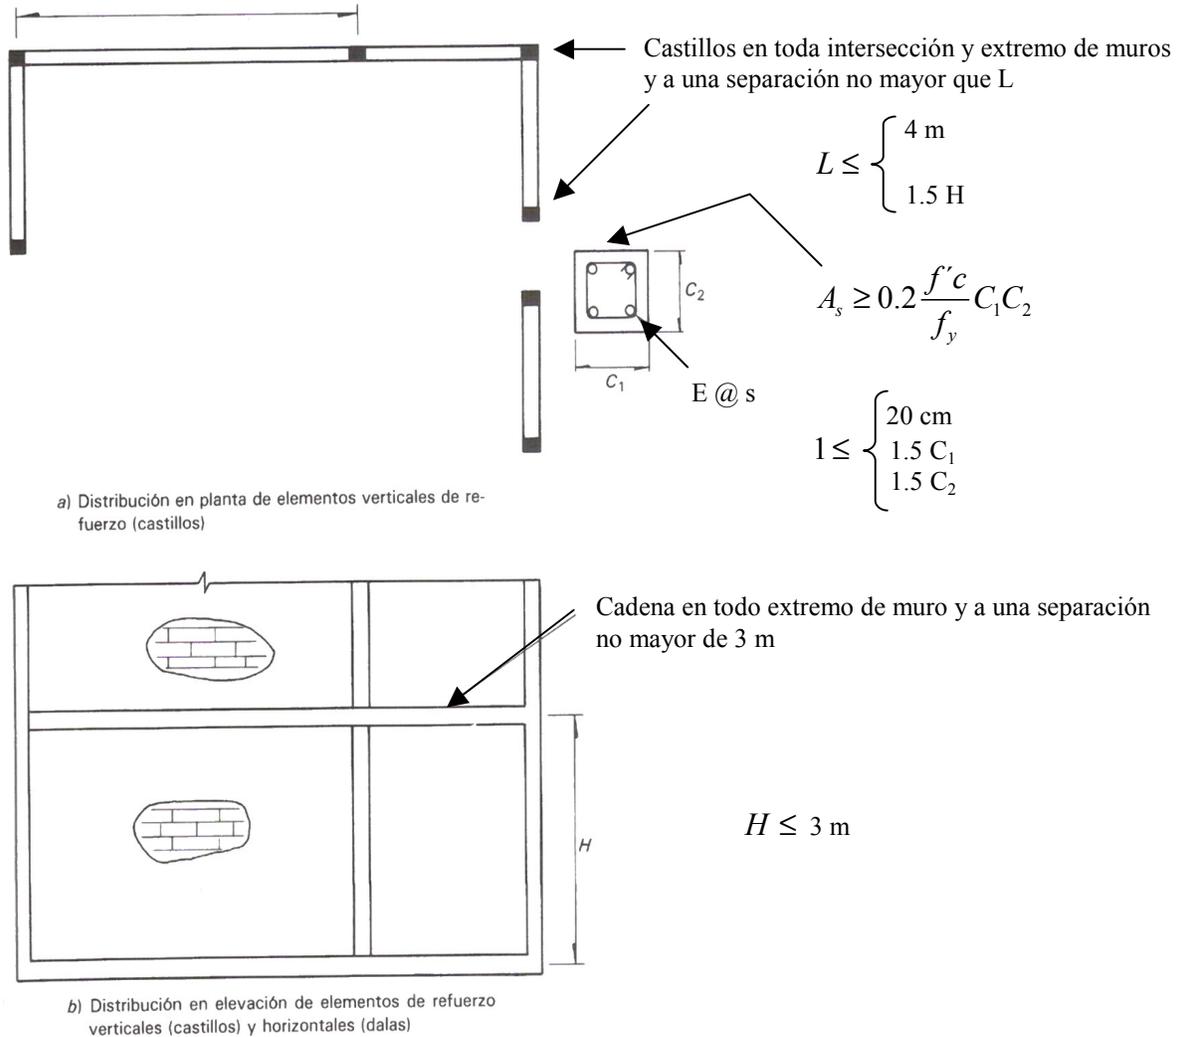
Requisitos del RDF para muros de mampostería confinada.
